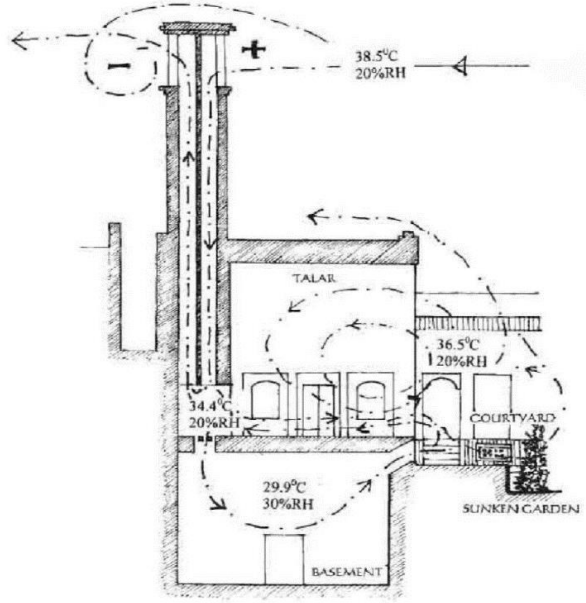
Rüzgar Kulelerinden Tünelden Hava Akış Planı
